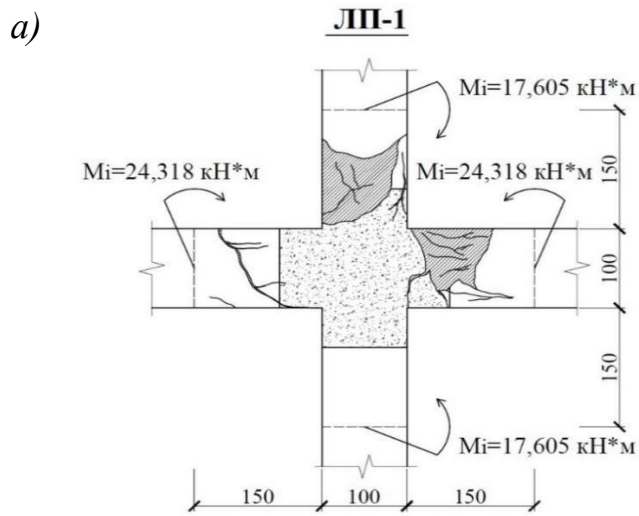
Руйнування стиснутої зони бетону перехресних балок: а – балки ЛП-1;
